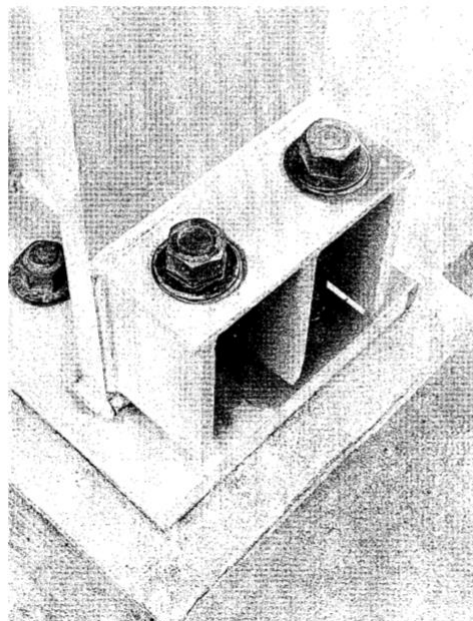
Fotografías de placas base-columna. Fuente: Alacero. Conexiones base-columna
